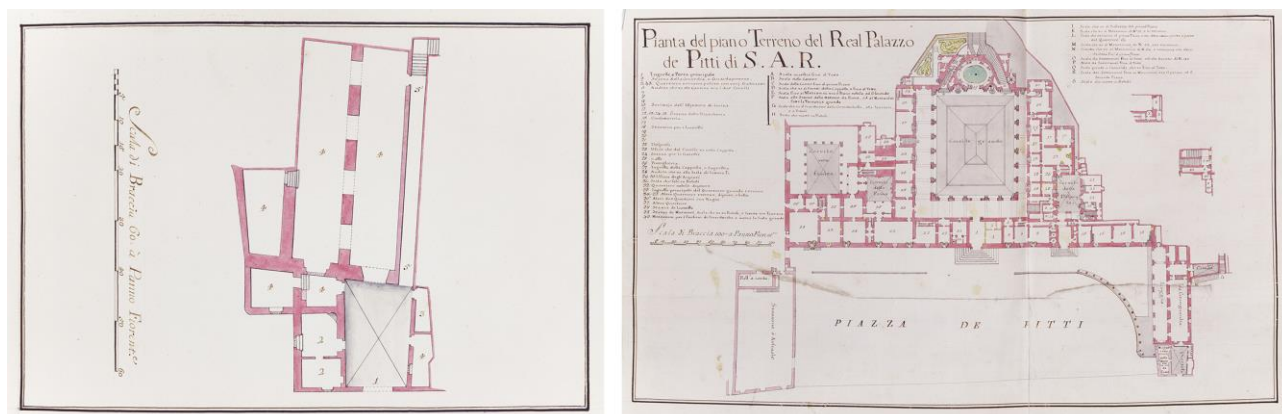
Anonimo, *Pianta del piano seminterrato del nuovo rondò e Pianta del piano terreno del Real Palazzo de' Pitti di Sua Altezza Reale* (Archivio Centrale di Stato di Praga, Archivio famiglia Asburgo Lorena, Cabreo B.A. 54, cc. 3-4).
